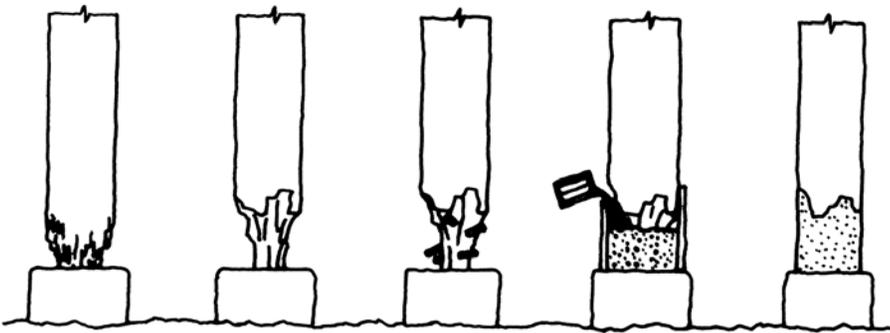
Consolidación del extremo inferior de un pie derecho con mortero epoxi.
